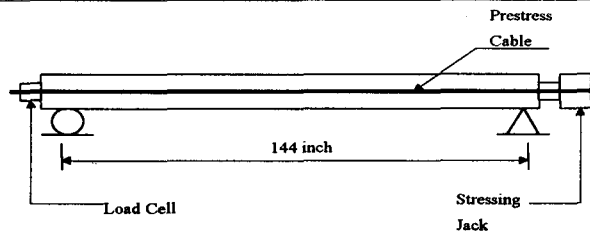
Prestressed Concrete Beam (1in=25.4mm)
